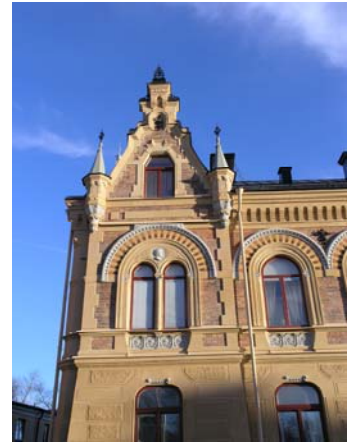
Fasaden efter renoveringen, med ny färgsättning. Foto KM.
